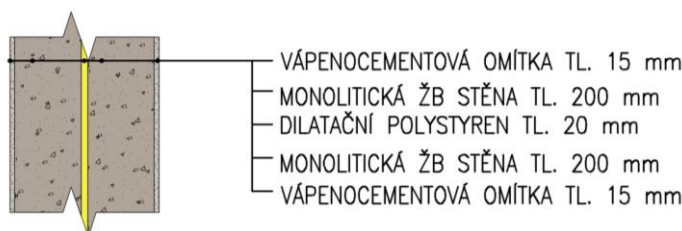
Skladba stávající dělicí konstrukce 1
